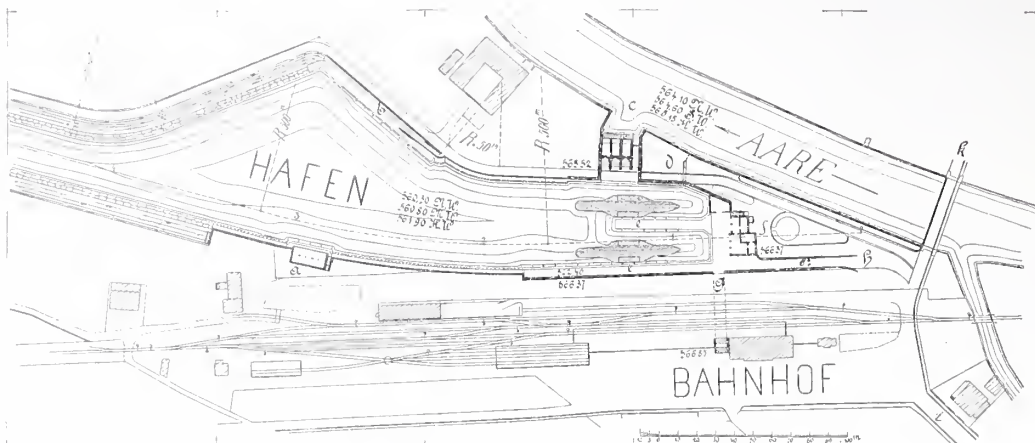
Lageplan der Hafenanlage in Interlaken. 1:4000.
